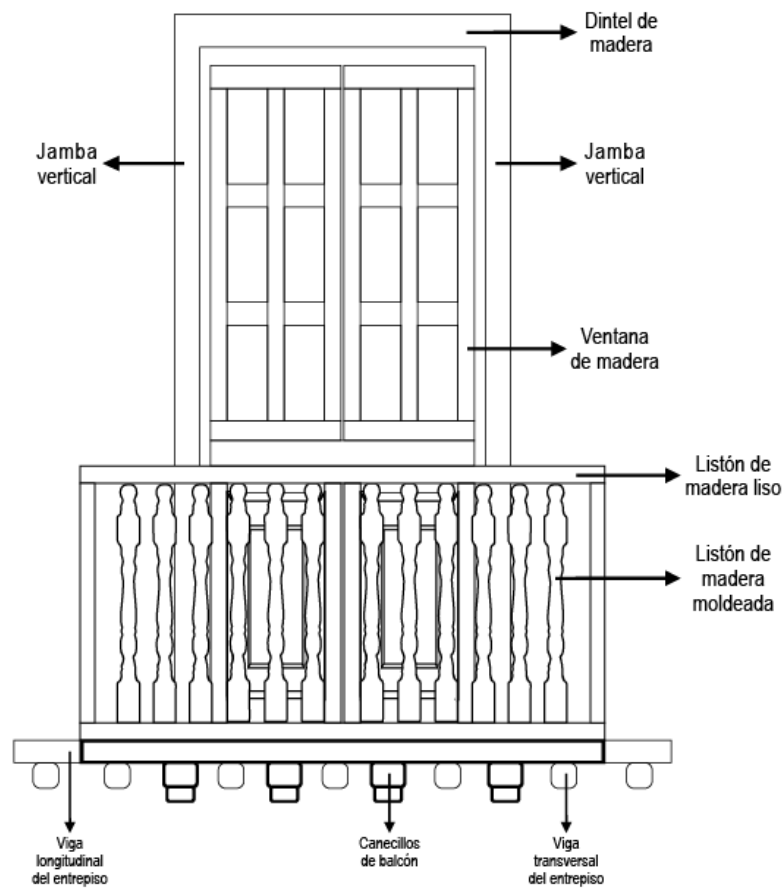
En la ilustración se observa la ventana de la planta alta tipo balcón original de la vivienda con un diseño ecléctico.
